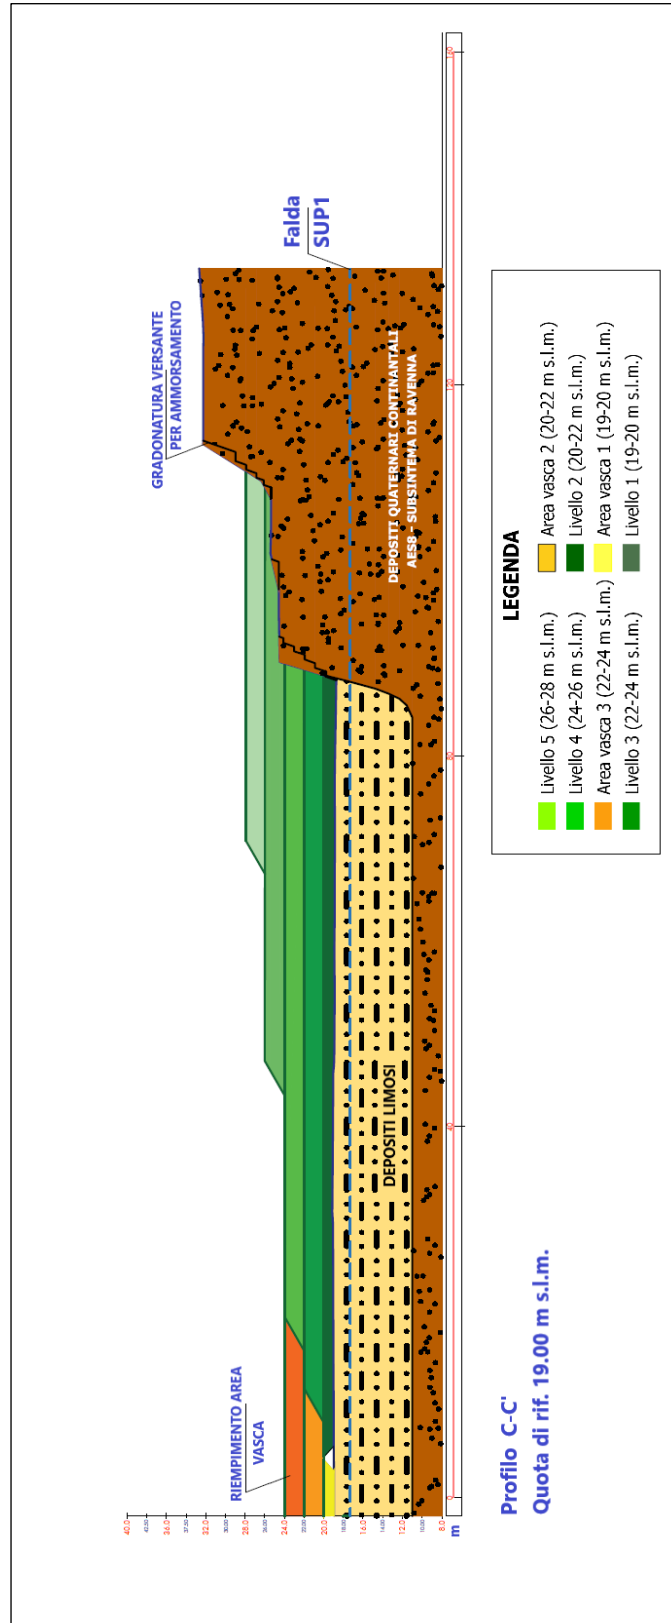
Sezione C- C' sul versante ovest di Cava Olmi
